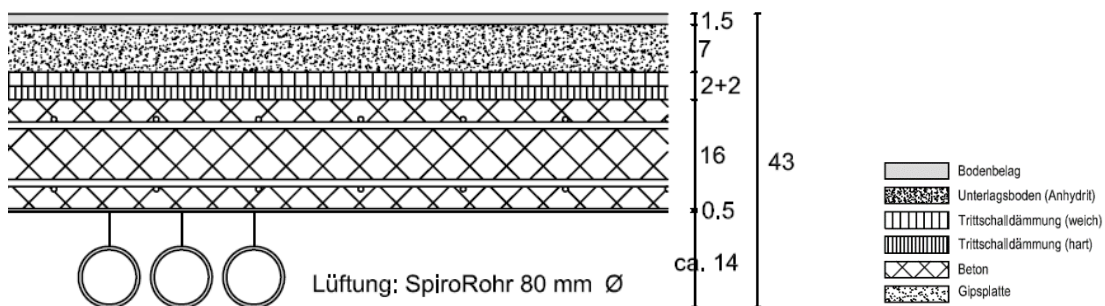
Querschnitt Variante 4 «Leitungen sichtbar geführt, Betondecke nach Statik dimensioniert (16 cm)» mit 70 mm Anhydrit-Unterlagsboden
